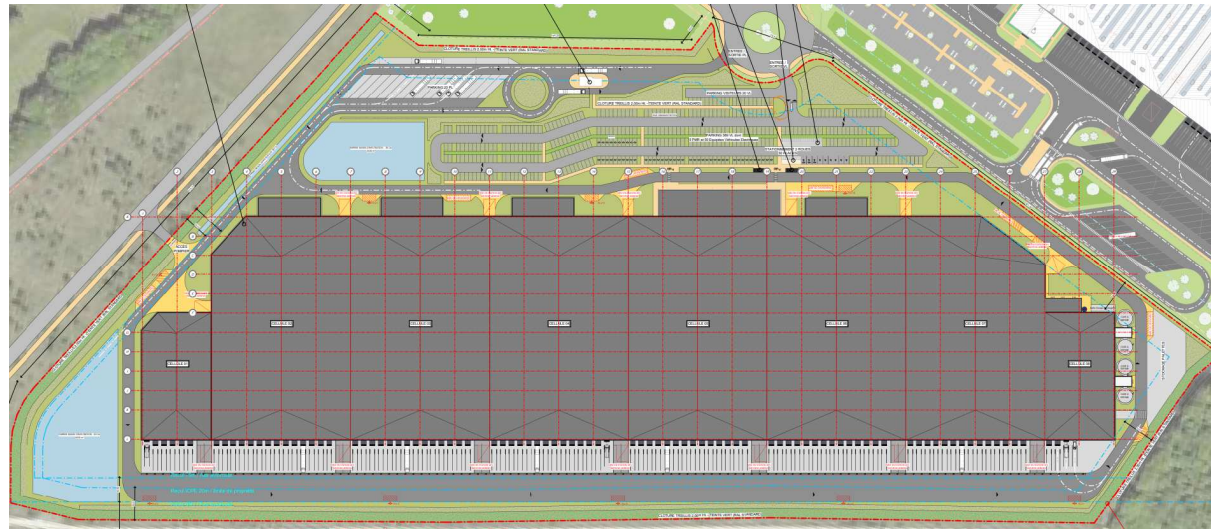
Plan de masse (Source : ARCHI-FACTORY)
